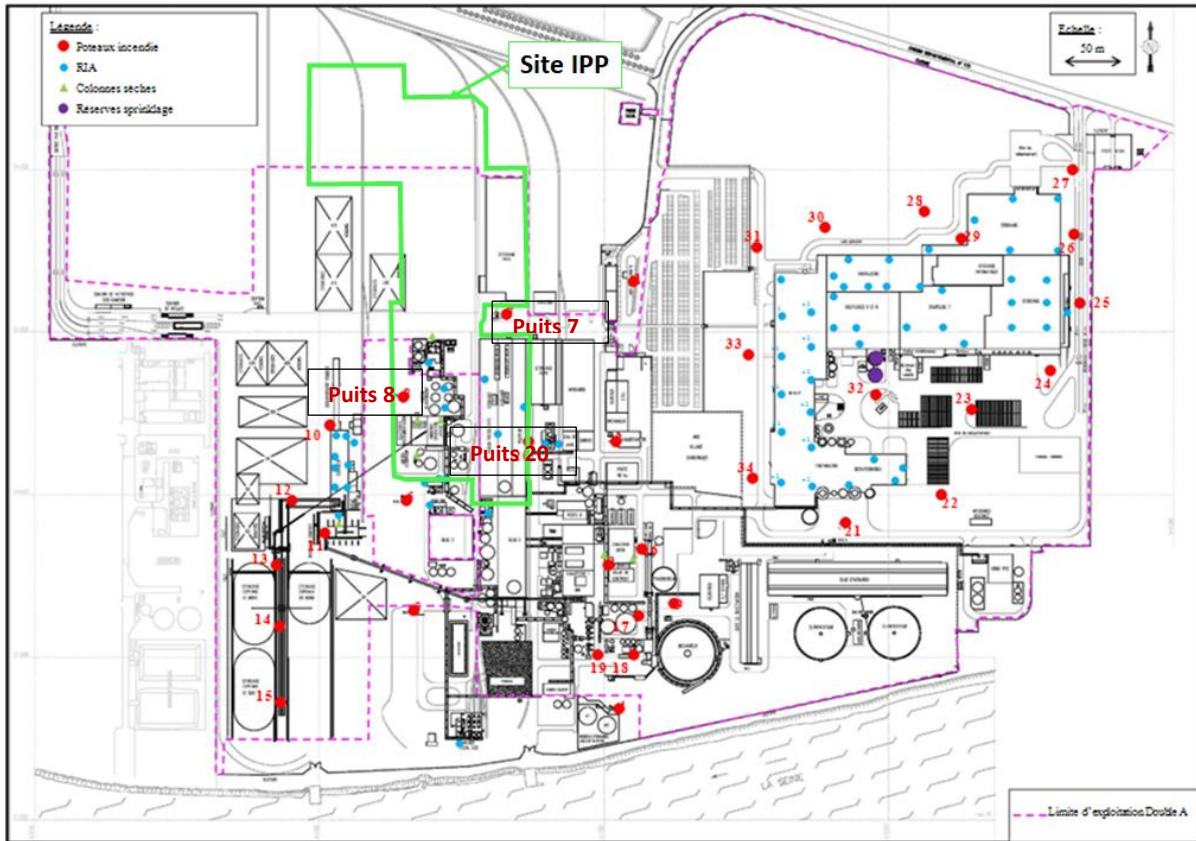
Plan des moyens d'intervention du site DOUBLE A
